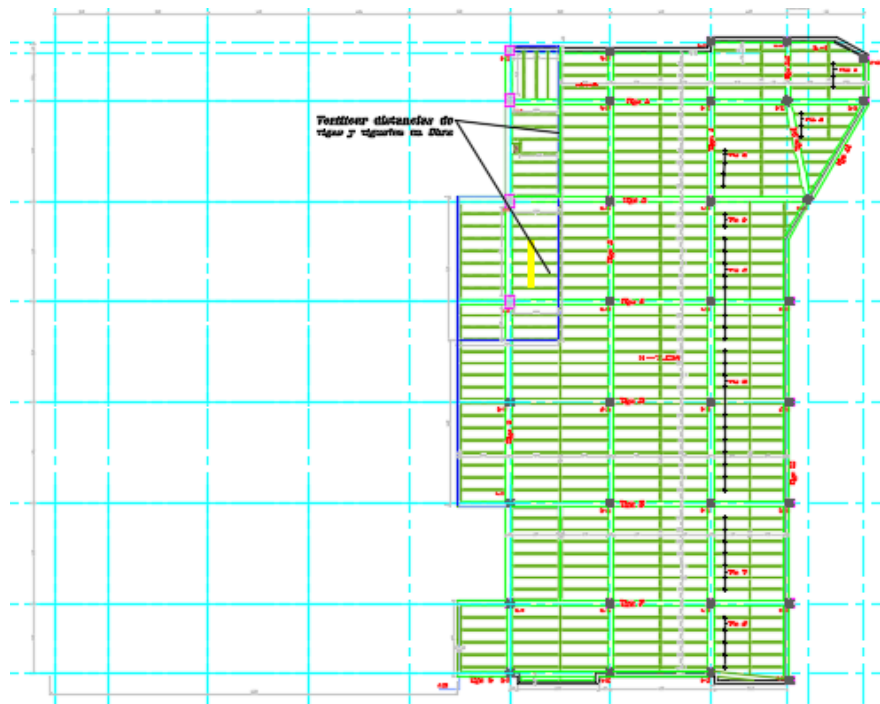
Planta estructural losa tipo N-400,N-700, N-1000.
